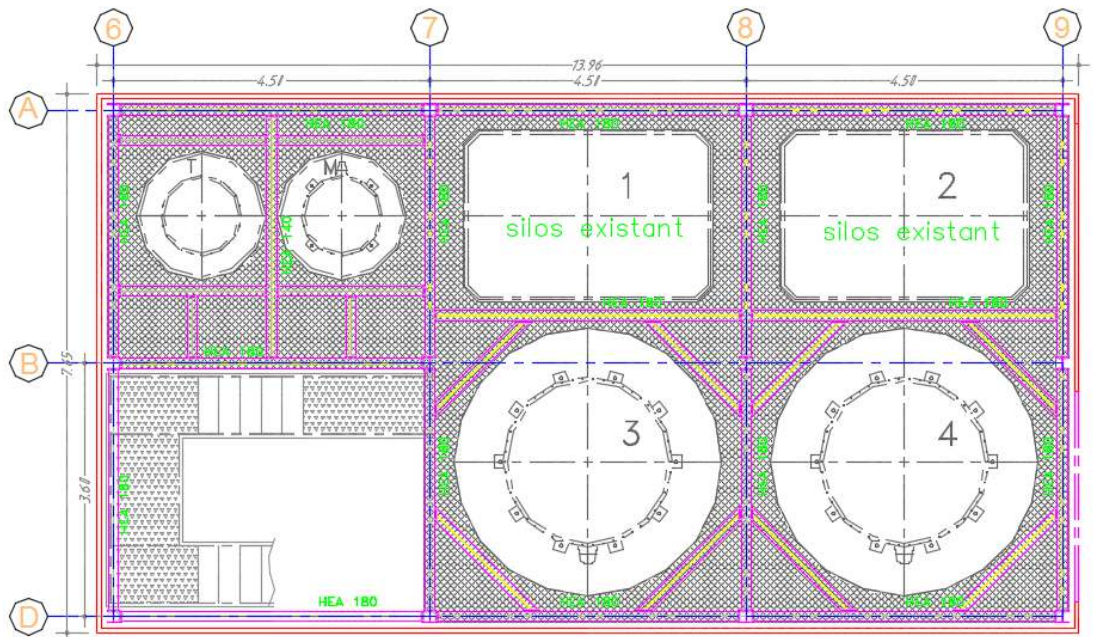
Vue en plan du Plancher Niveau +14.71
